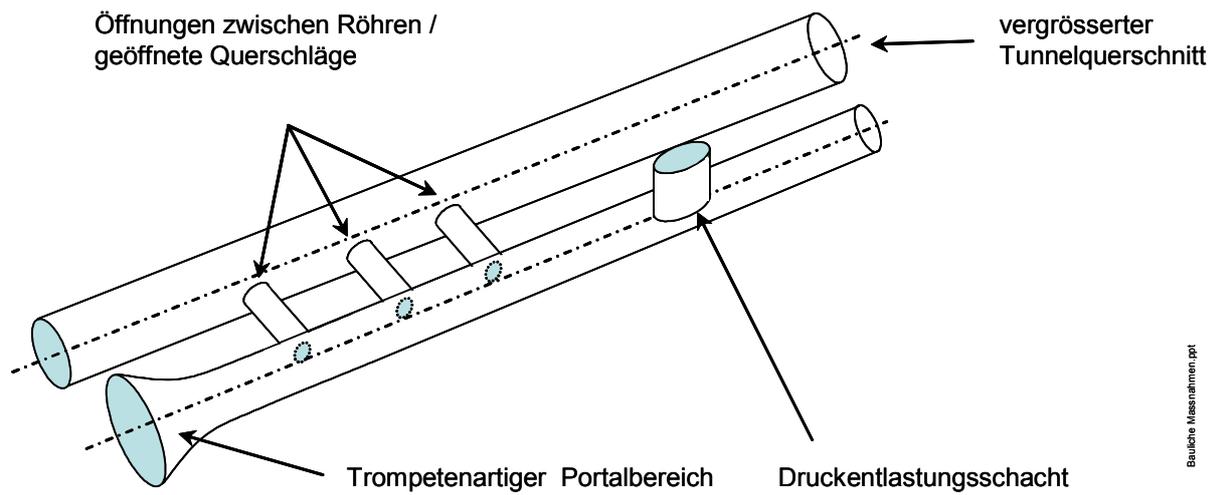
Bauliche Maßnahmen an Tunnelbauwerken zur Verringerung von Druckschwankungen in Tunneln und Reisezügen
